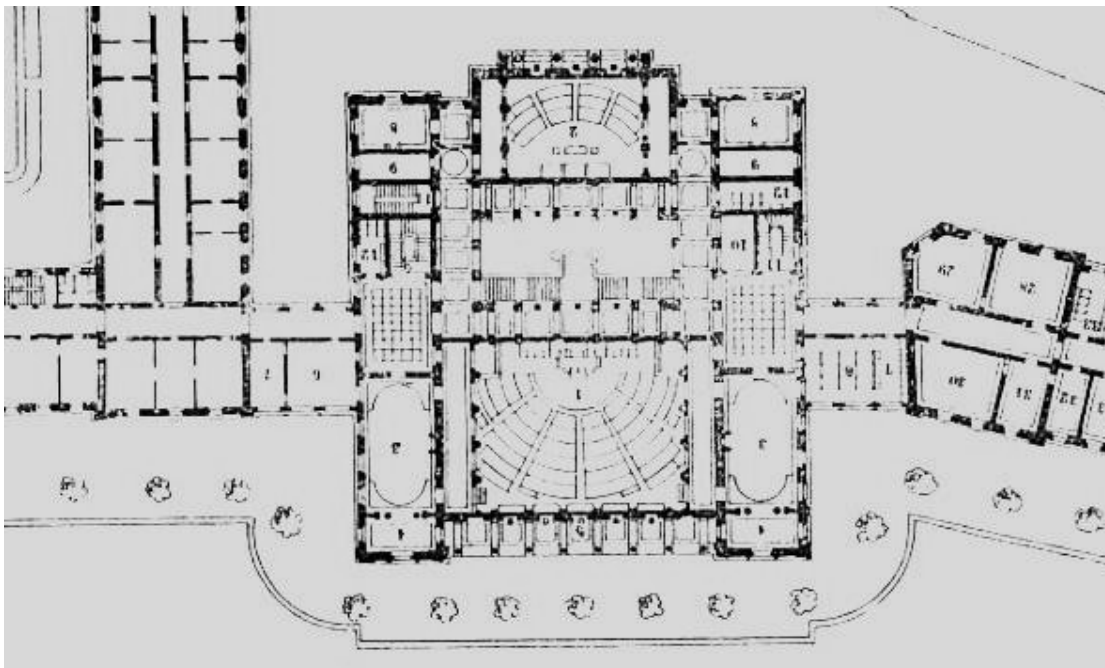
Grundriss Hauptgeschoss, Hirsbrunner/Baumgart.
